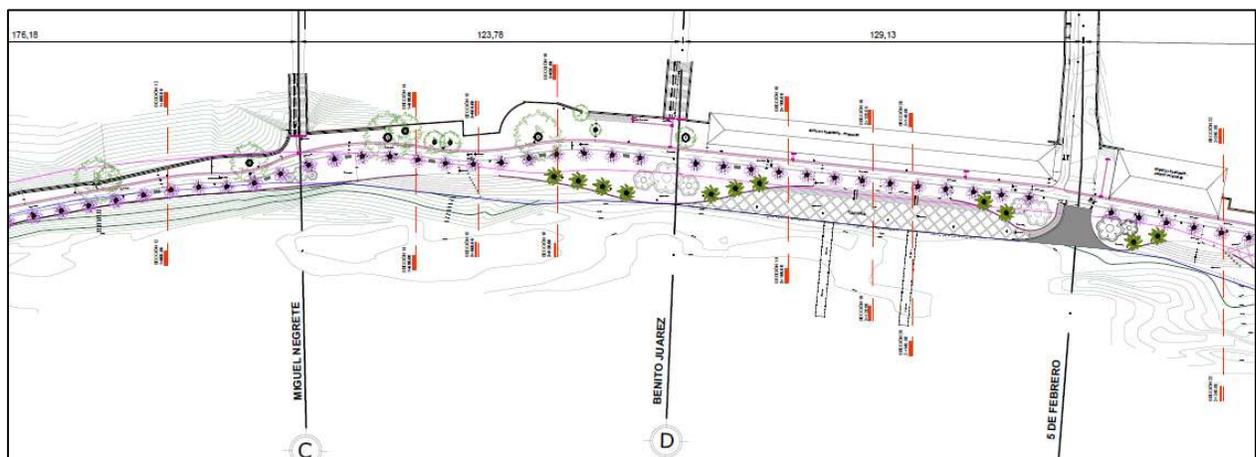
Planta arquitectónica Sección 2 del proyecto
